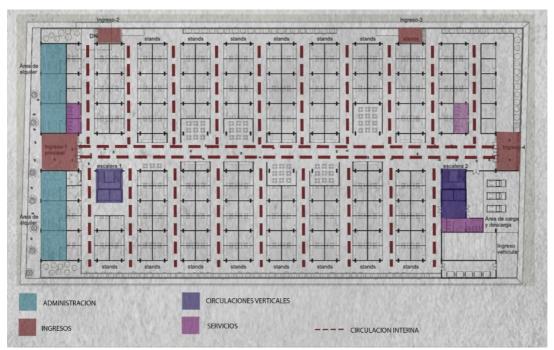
Planta baja mercado por Arquitectura Verde. Elaboración propia
